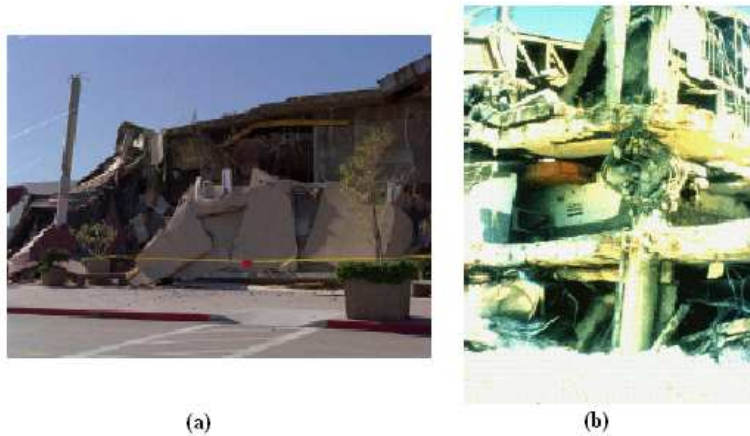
Ruptura em estruturas com lajes lisas (adaptado de Binici, 2003)
